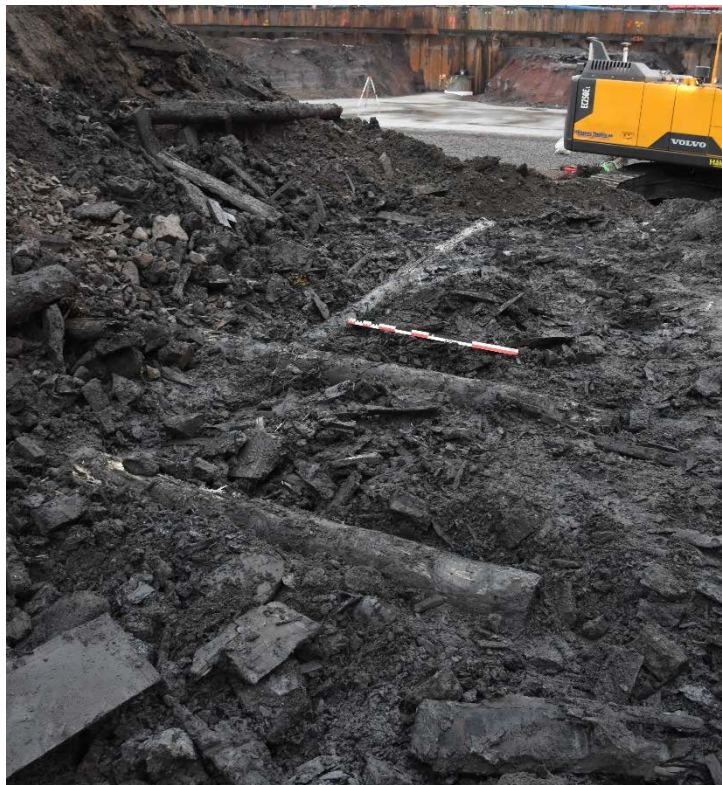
Plankedekket like under bolverk K18. Foto tatt mot sør-øst av Joachim Åkerstrøm, NMM.
